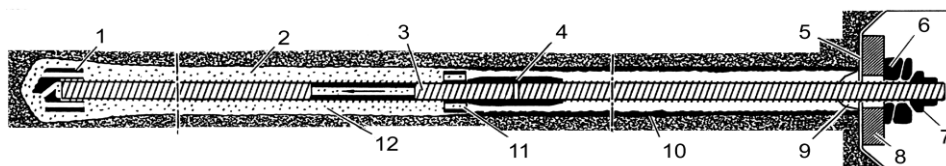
Схема установки инъекционного анкера: 1 – крестообразная коронка с направляющей трубой; 2 – впрессовываемое тело; 3 – винтовая арматура; 4 – соединительная гайка; 5 – шпунтовая стенка; 6 – две клиновидные шайбы; 7 – гайка с фланцем; 8 – пластина для распределения нагрузки; 9 – пакер; 10 – корж; 11 – распорка; 12 – цементный камень.
